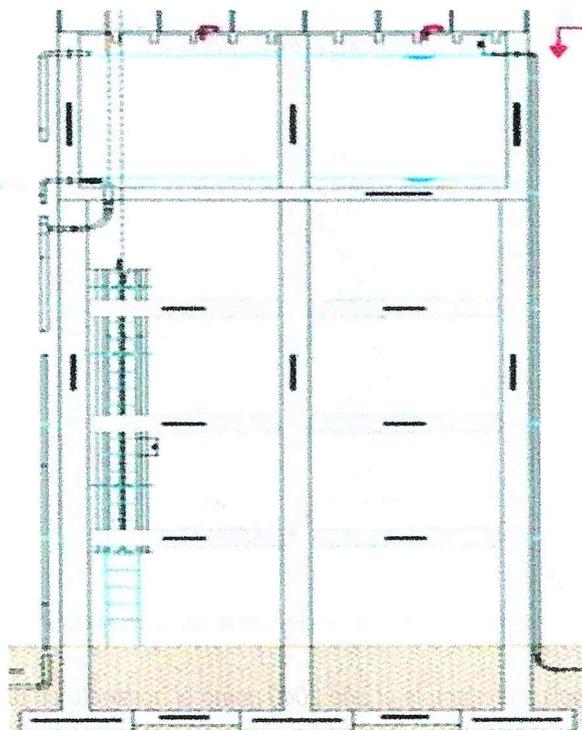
Planta de tratamiento modulares compactas en PRFV - Planta de tratamiento en fibra de vidrio
